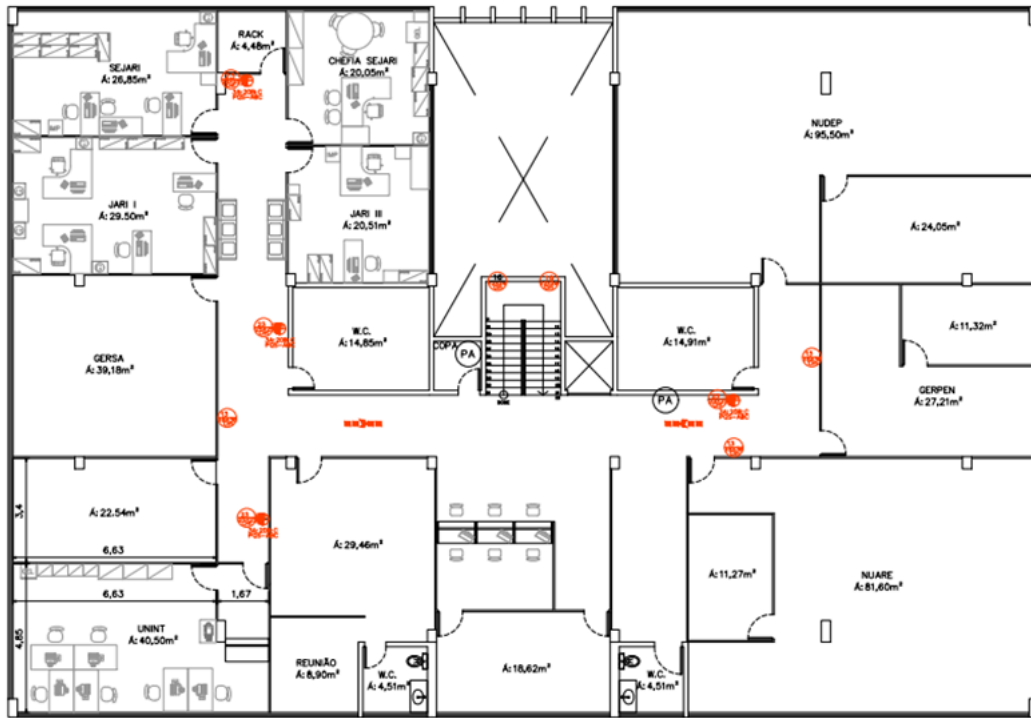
Planta-baixa/Layout Atual Unidade DETRAN/DF Setor de Cargas (Antiga Vadel) – Endereço atual: STRC, Trecho 1, Conjunto B, Lts 01/08, Zona Industrial, Guará-DF
